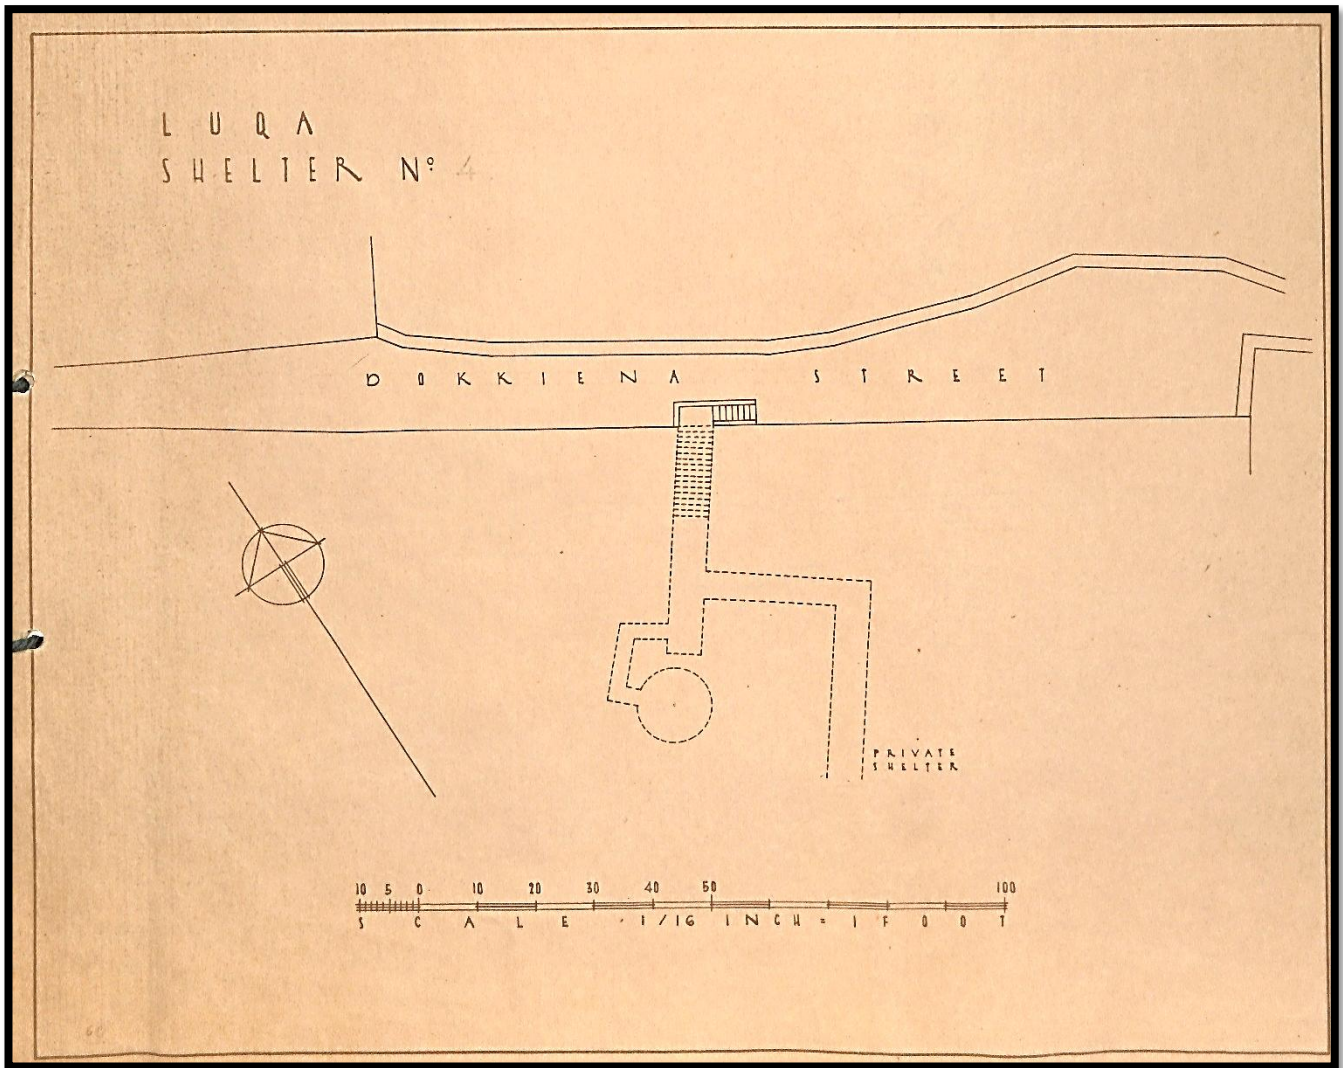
Planta do Abrigo nº4 "Dokkiena Street"
